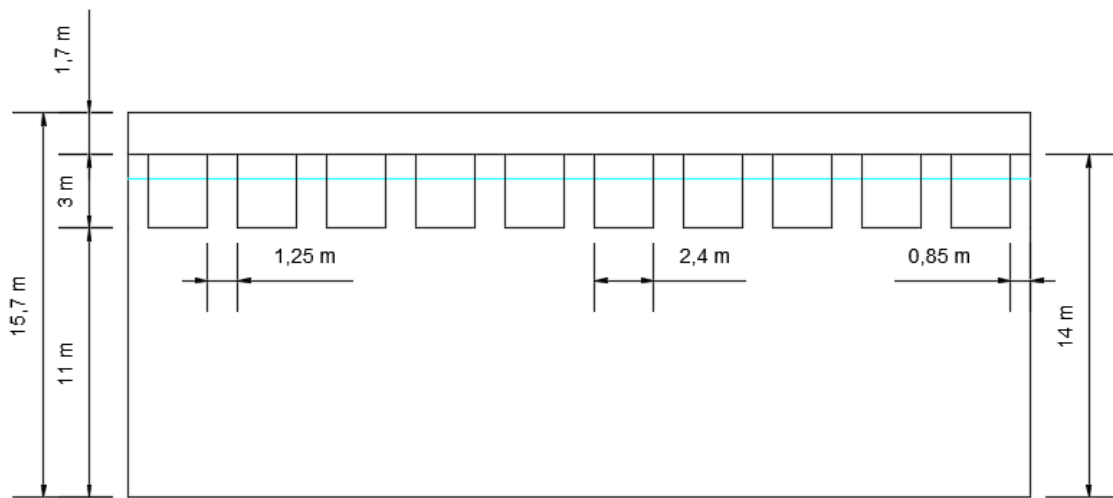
Geometría del cajón antirreflejante en alzado para el oleaje. Fuente: Propia
